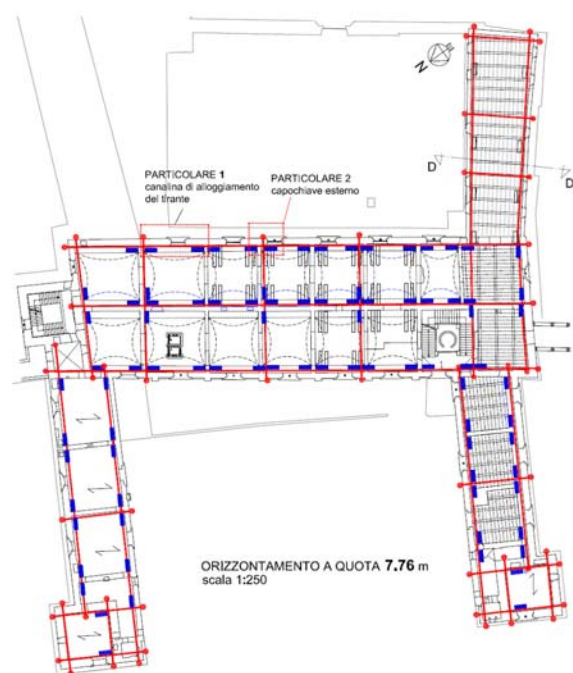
Disposizione planimetrica dei tiranti metallici a pavimento.
